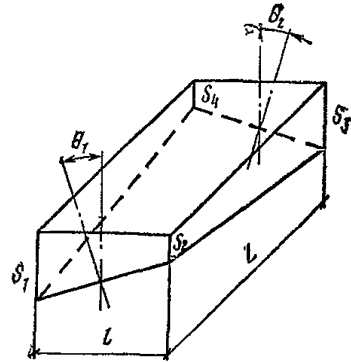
Схема осадок, вызывающих кручение здания (сооружения)
